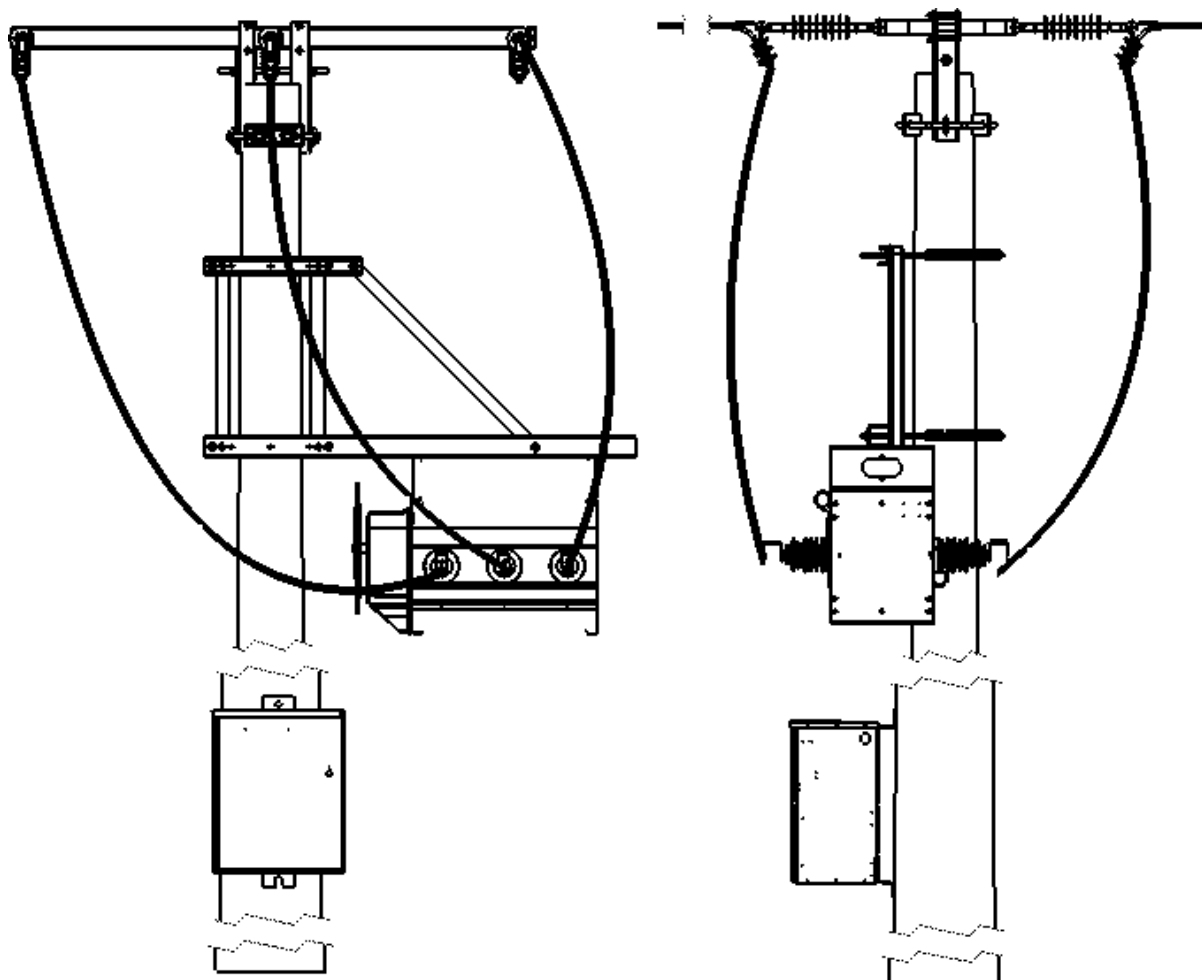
Montaż NXA na 1 słupie okrągłym betonowym, poniżej poprzeczki, działanie silnikowe
